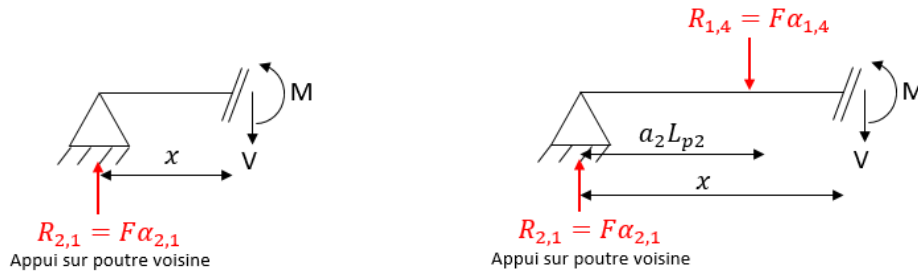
Poutre type 2 – coupe 1 (gauche) et coupe 2 (droite)
